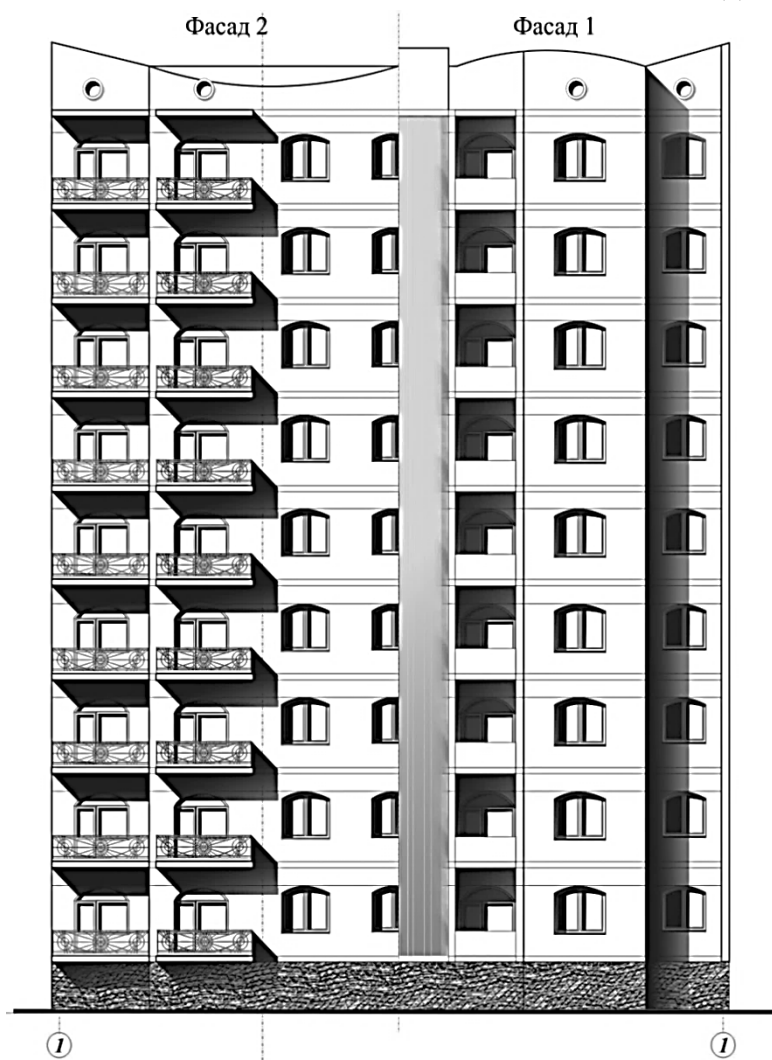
Архитектурные решения совмещенных фасадов здания А
